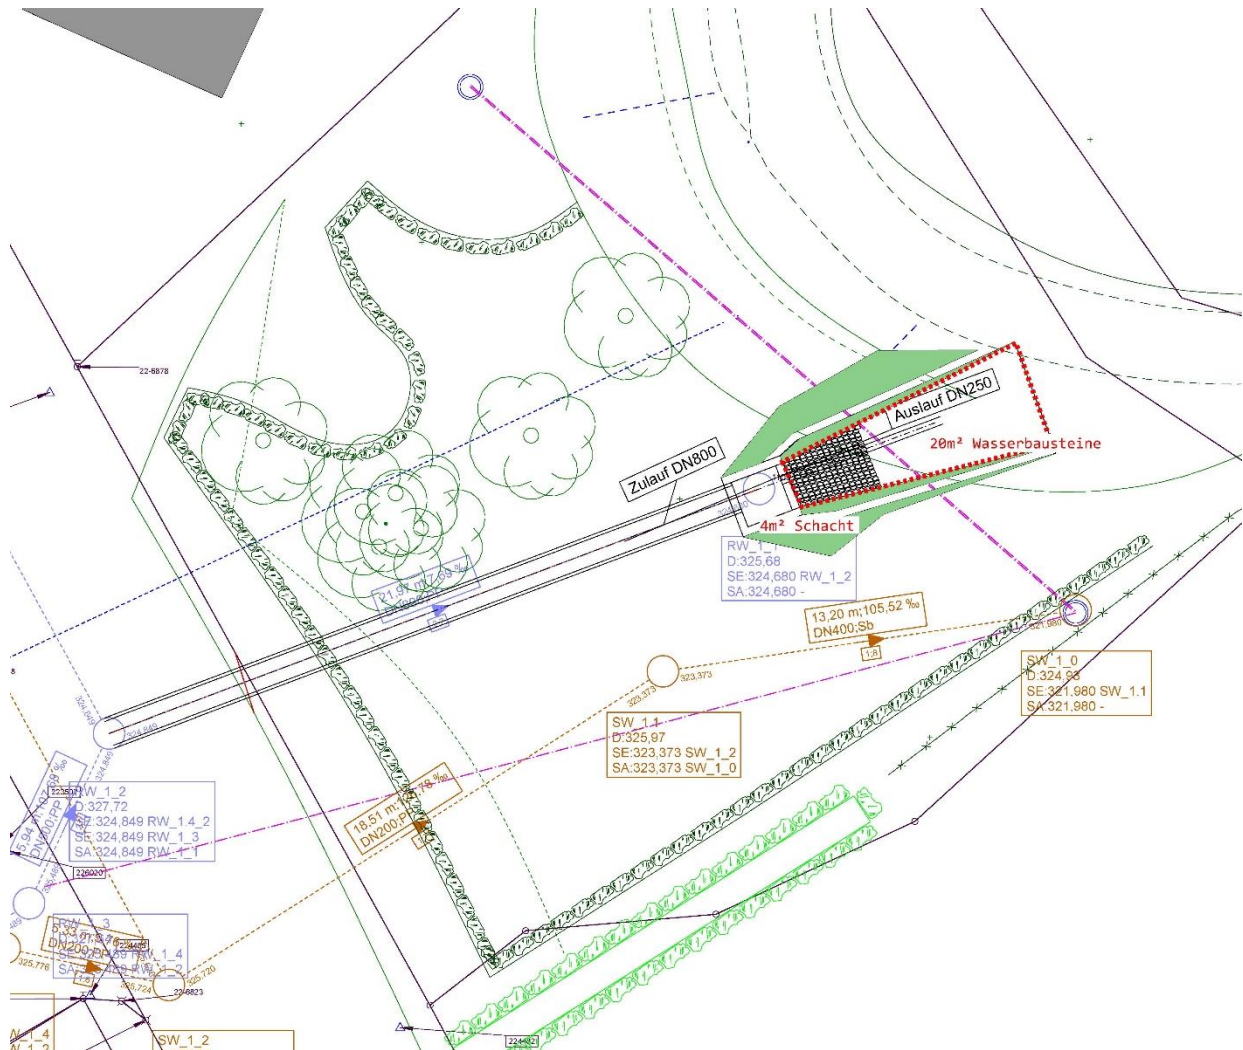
Lageplan Drosselbauwerk mit Zuleitung, Quelle: (Architekturbüro Würmseher 2024)
